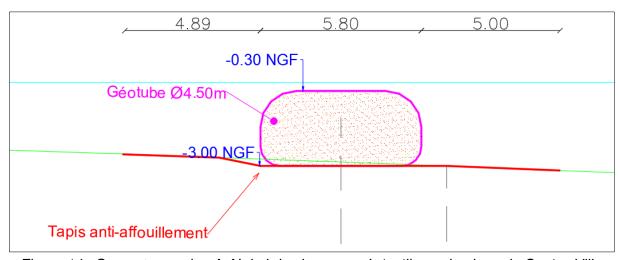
Coupe type selon A-A' du brise lame en géotextile sur la plage du Centre-Ville
